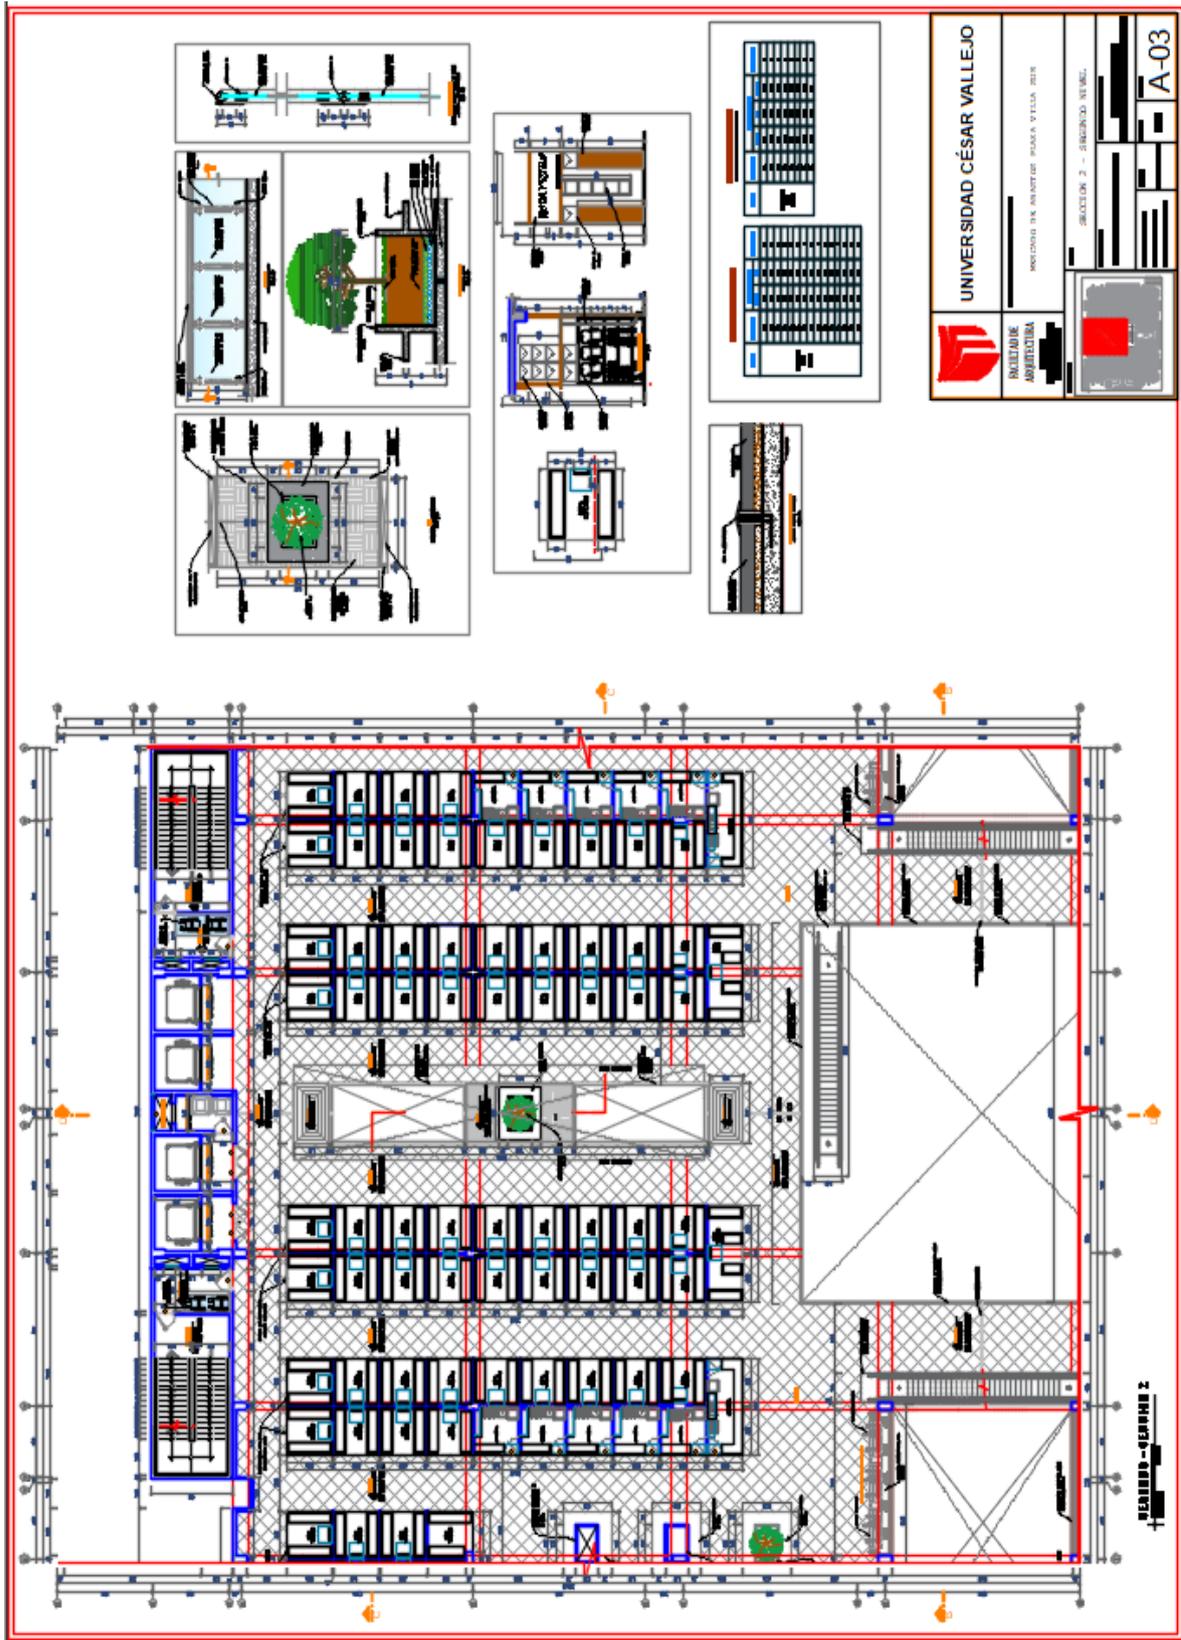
Plano de Arquitectura – Plano de secciones – segundo piso
